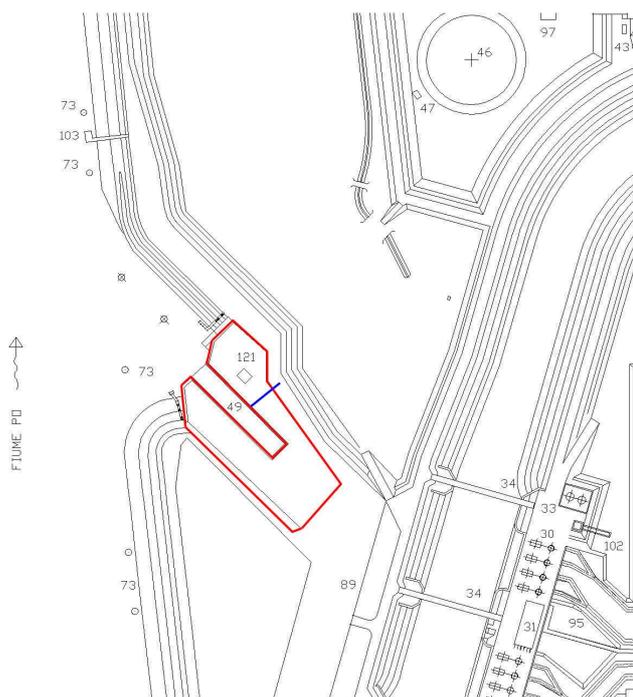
Estratto della planimetria della centrale: darsena attracco bettoline e relativo tratto di tubazione interrata (in colore blu)
